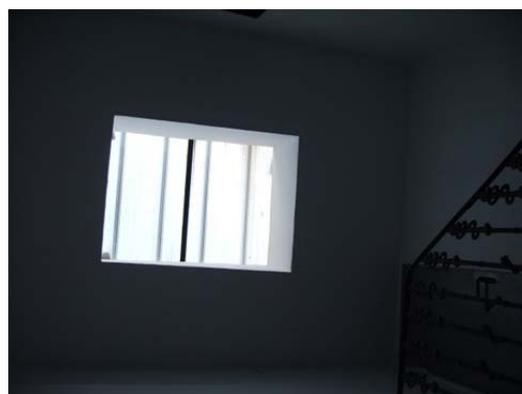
Revestimientos verticales planta tercera y bajo-cubierta
